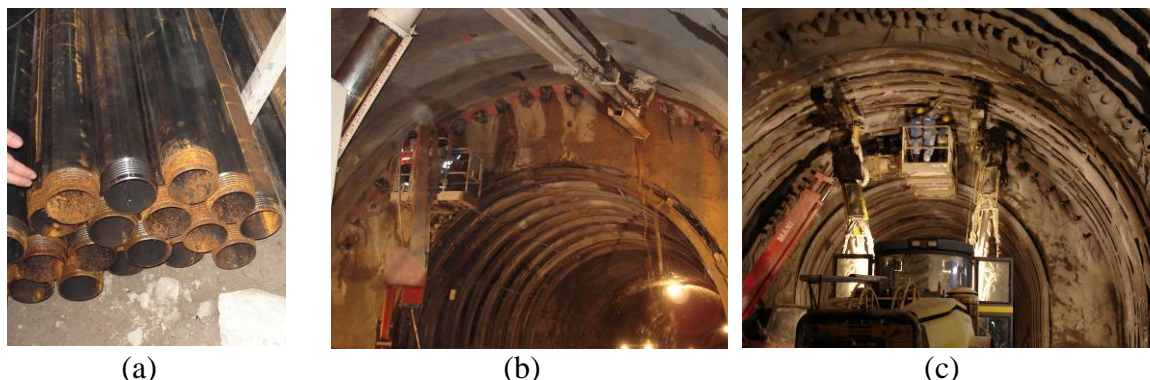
Pormenorização das enfilagens: (a) tubagem metálica utilizada para o encamisamento da enfilagem; (b) exemplo de execução de furação das enfilagens e (c) exemplo de enfilagens e furação de novo nível
